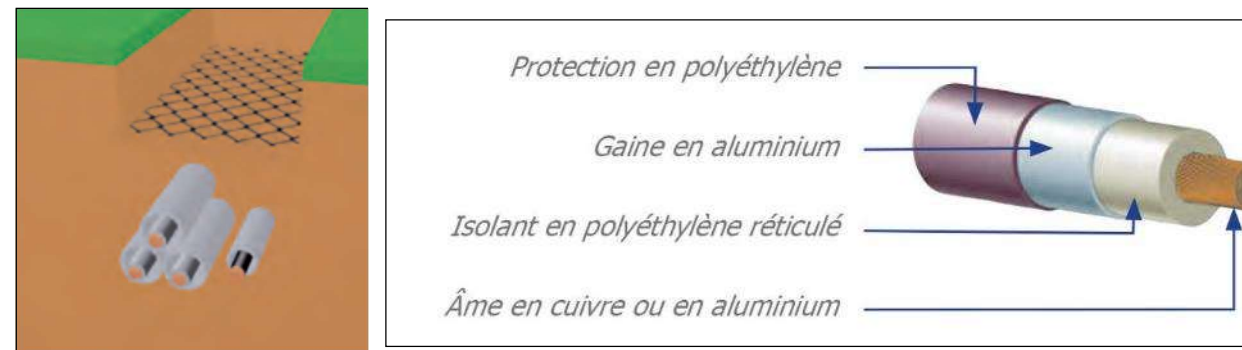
Principe d'enfouissement et coupe d'un câble de raccordement souterrain (source : RTE)
